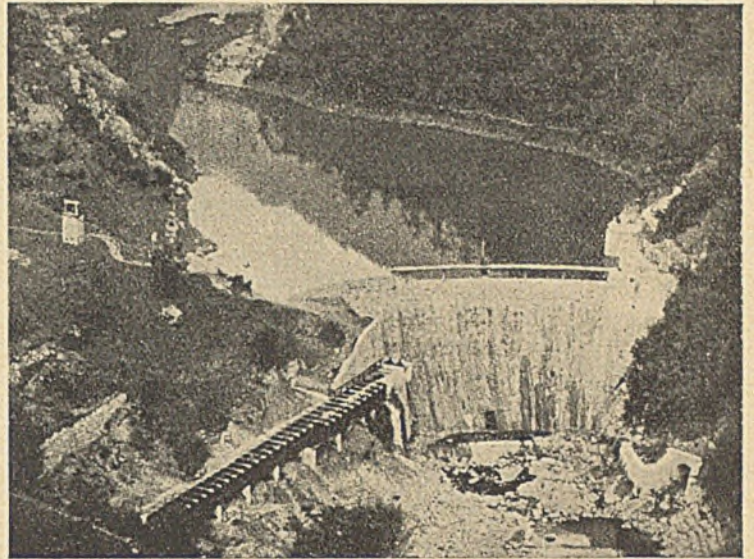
Gesamtansicht der Sperrmauer mit Wasserfassung und Entlastungsvorrichtungen.
